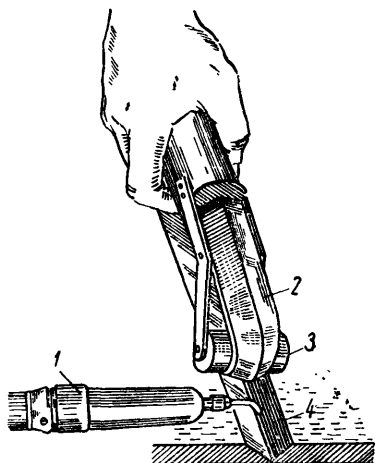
Сварка стыков линолеума горячим воздухом:
